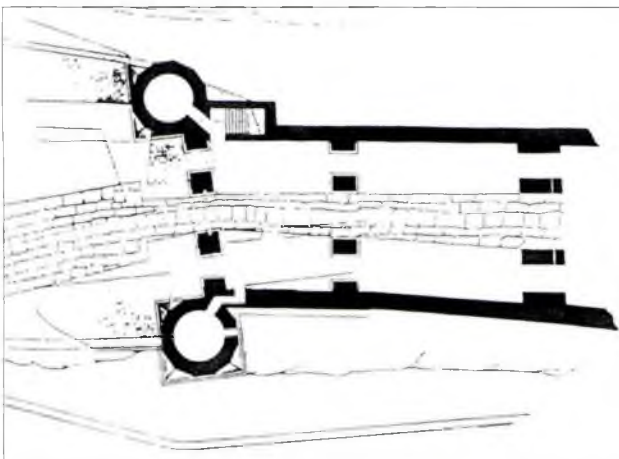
Planta de la Puerta de *Hispellum* (Spello) (de U. Carchi).
